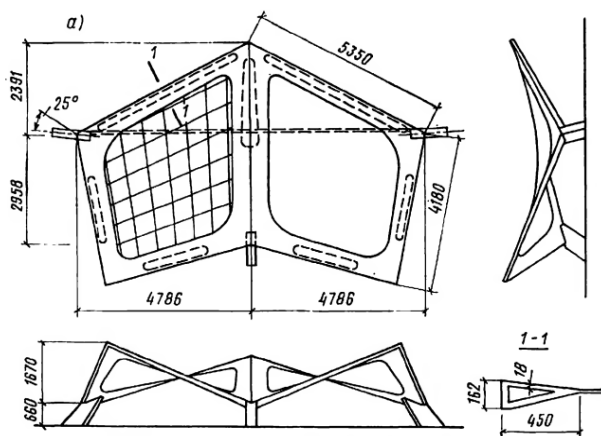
Монолитная железобетонная оболочка плавательного бассейна в Гамбурге. Конструктивная схема оболочки
